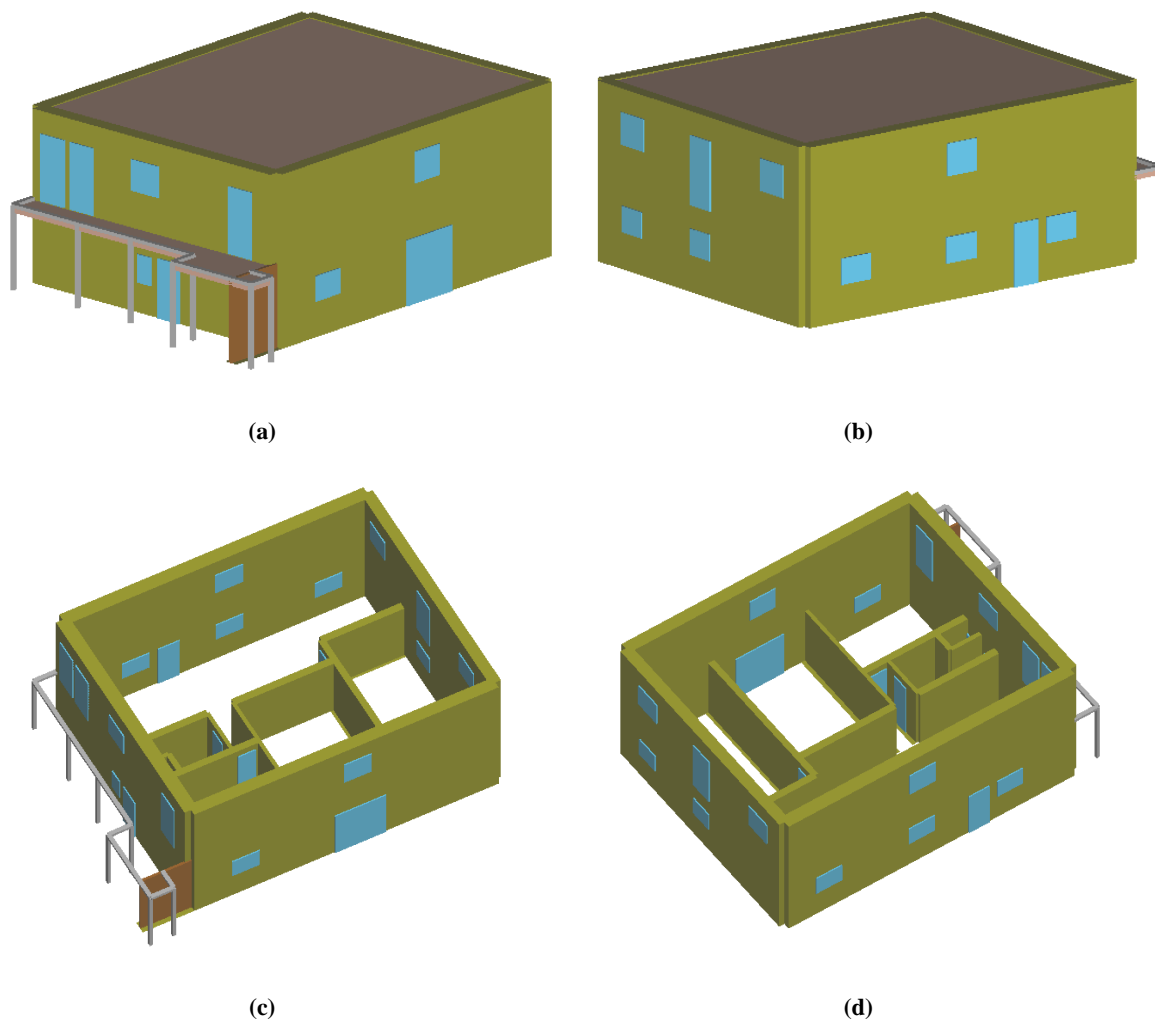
Modelos 3D do programa 3Muri do edifício em estudo (a) fachadas norte e tardoz com visualização de pavimentos; (b) fachadas sul e principal com visualização de pavimentos; (c) fachadas norte e tardoz sem visualização de pavimentos; (d) fachadas sul e principal sem visualização de pavimentos
